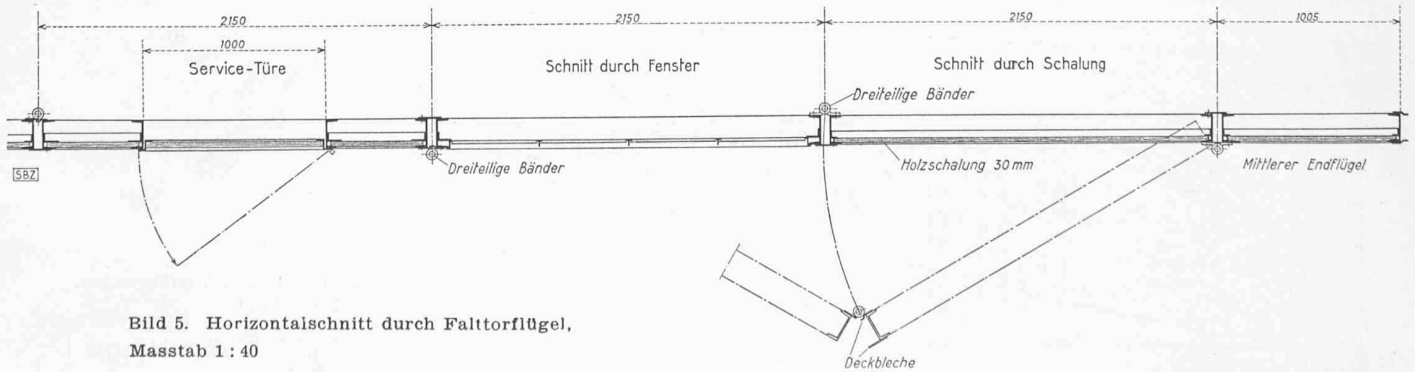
Horizontalschnitt durch Falttorflügel, Masstab 1 : 40
